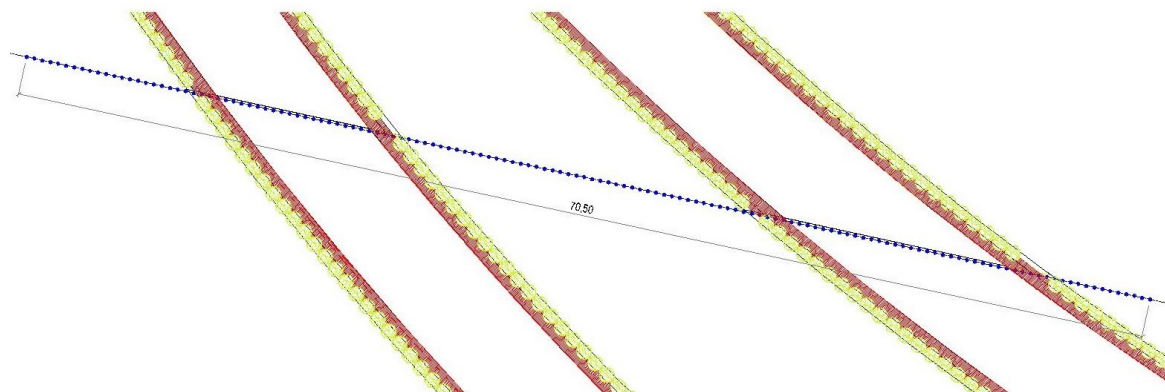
Pianta dei manufatti oggetto della presente relazione di calcolo.
